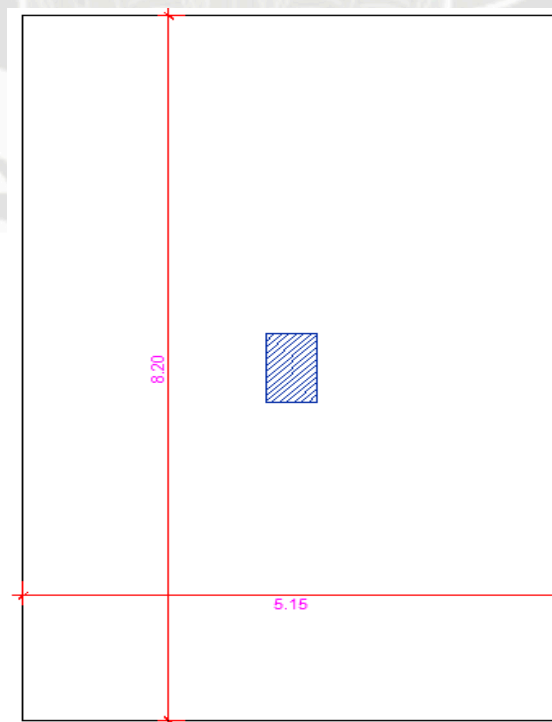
b. Área de influencia Zapata aislada
